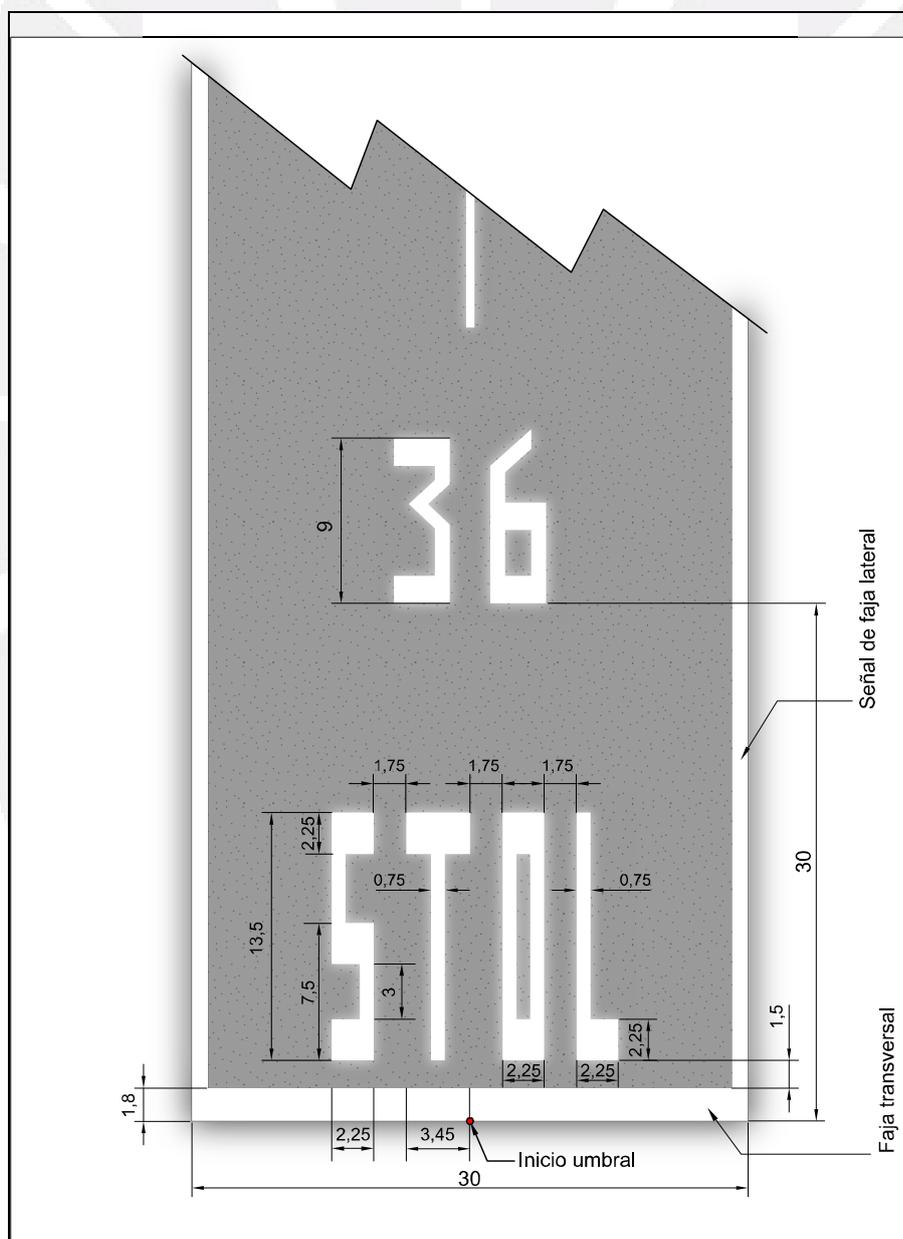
Señal de umbral STOL en pistas pavimentadas
